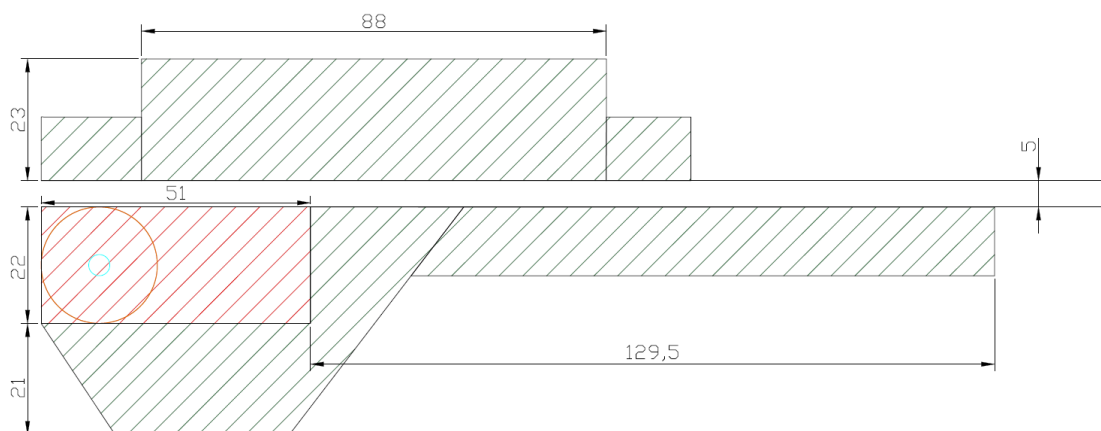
Tipico piazzola di cantiere con quote espresse in metri.
